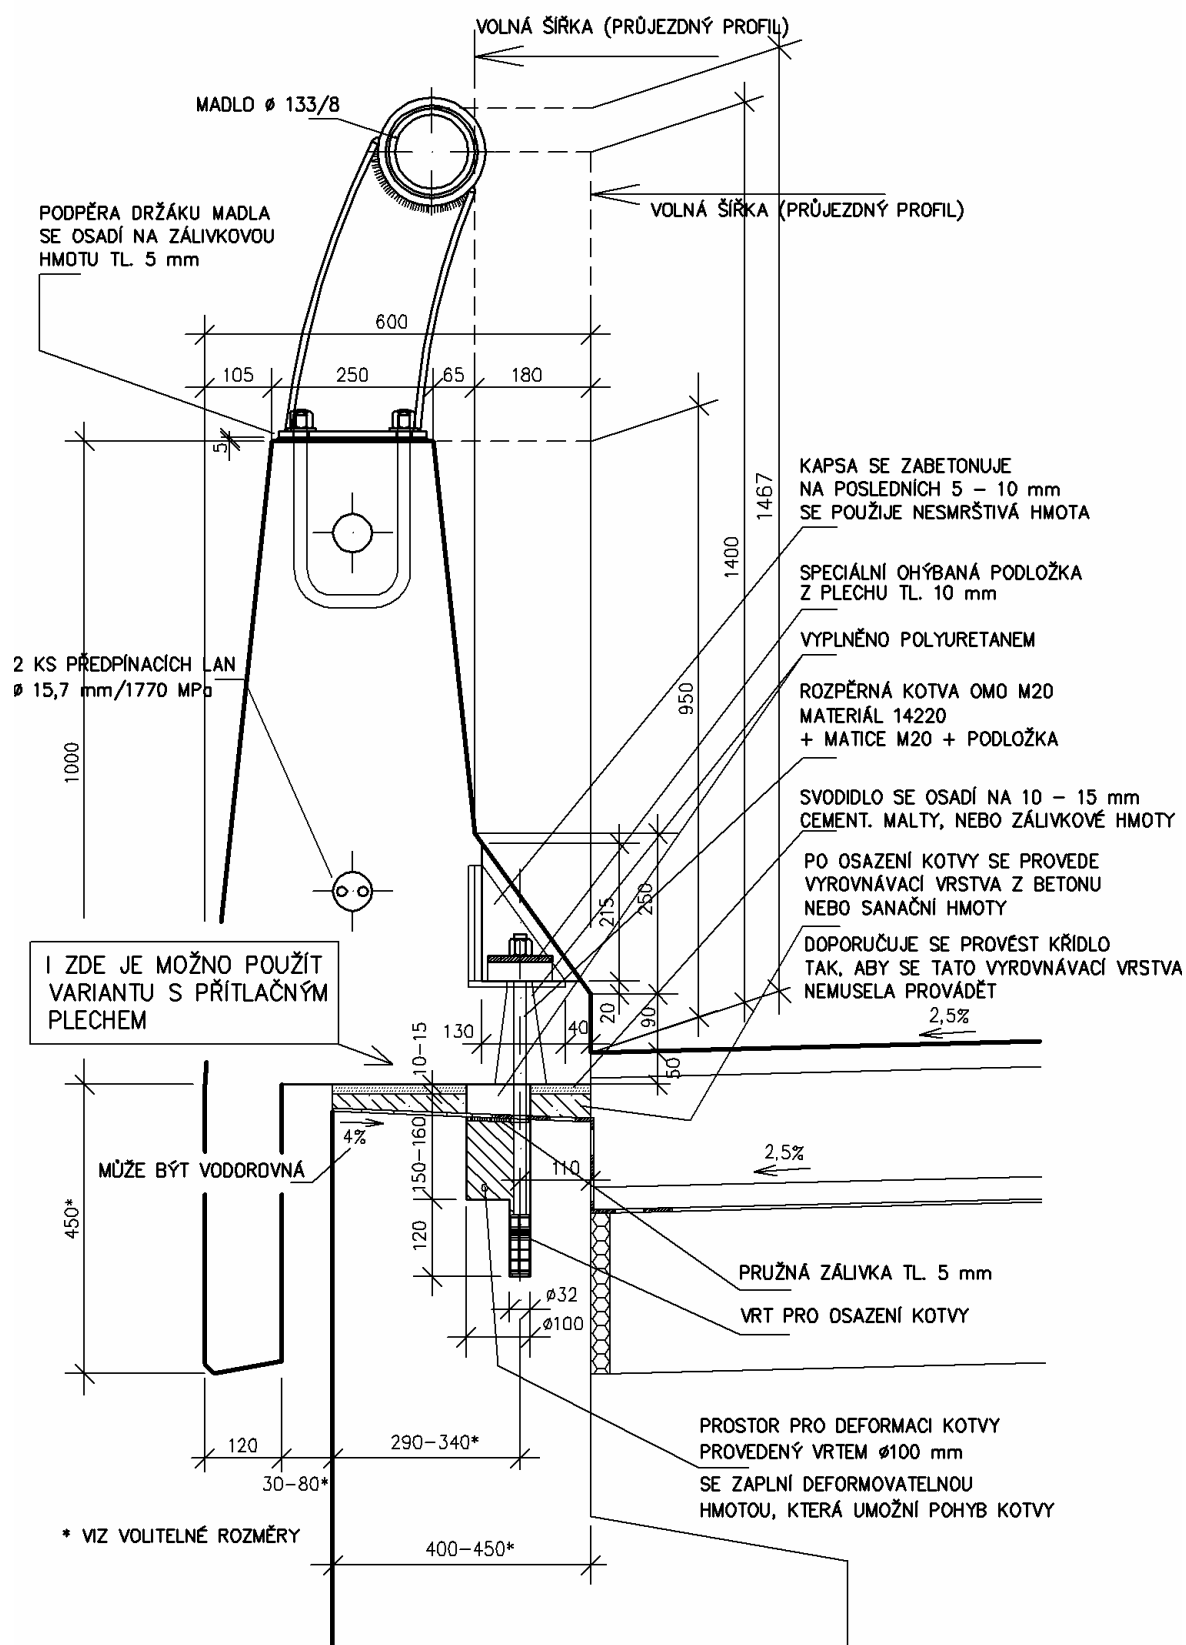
Osazení svodidla – zvýšený okraj nosné konstrukce – vozovka 140 mm varianta s přítláčným plechem izolace
